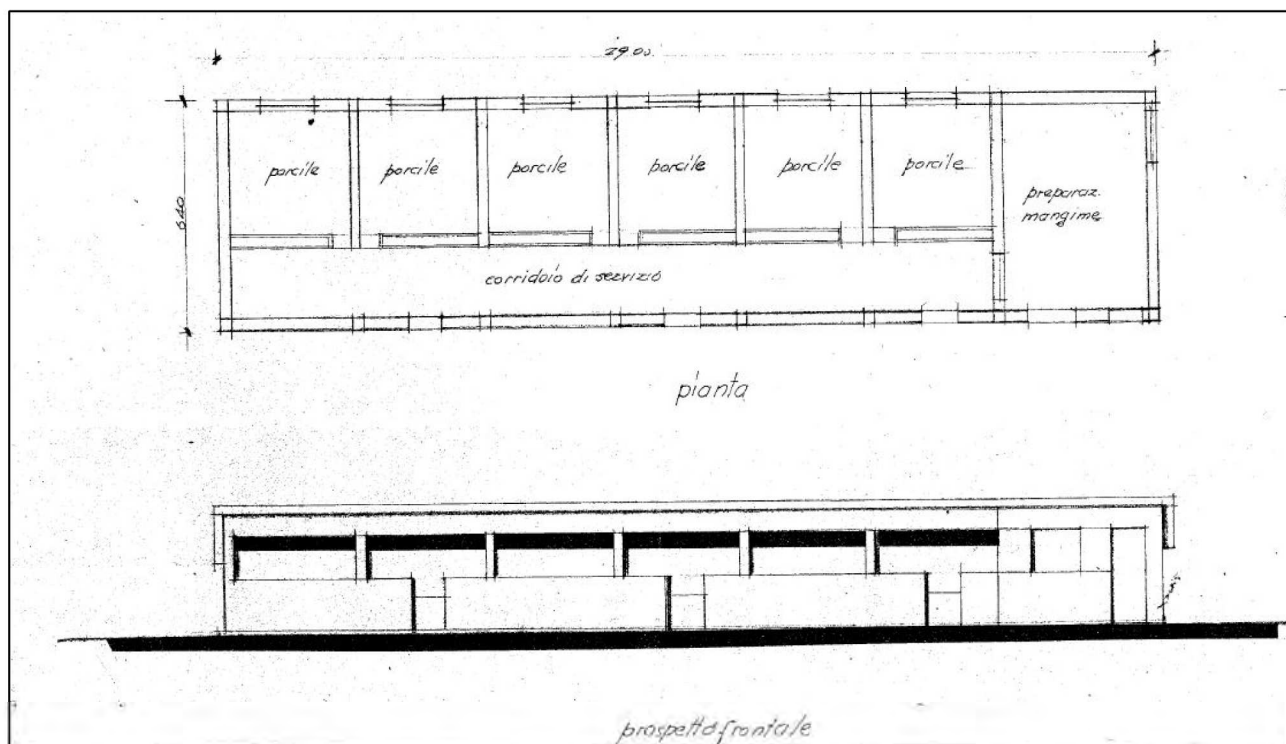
Planimetria e prospetto frontale stalla - Licenza a costruire in variante n. 24bis del 18.07.1973
